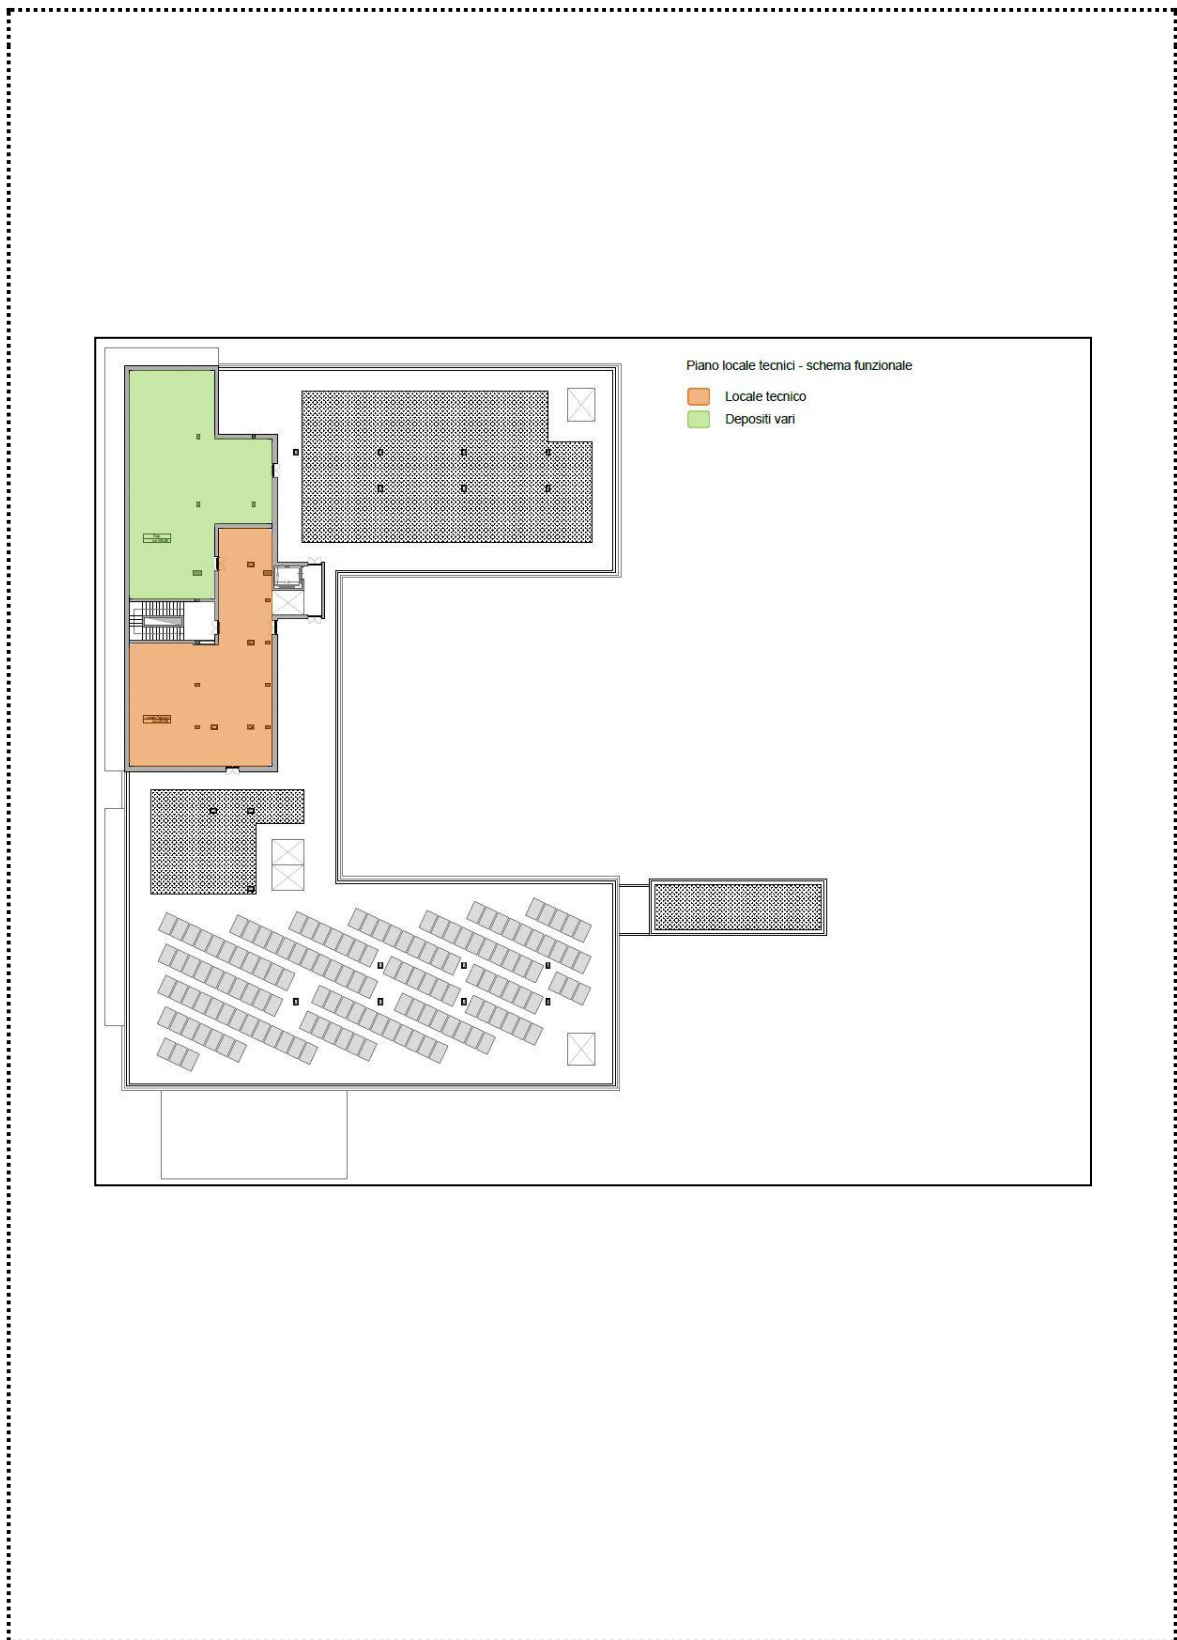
Schema funzionale pianta piano locale tecnico RSA
